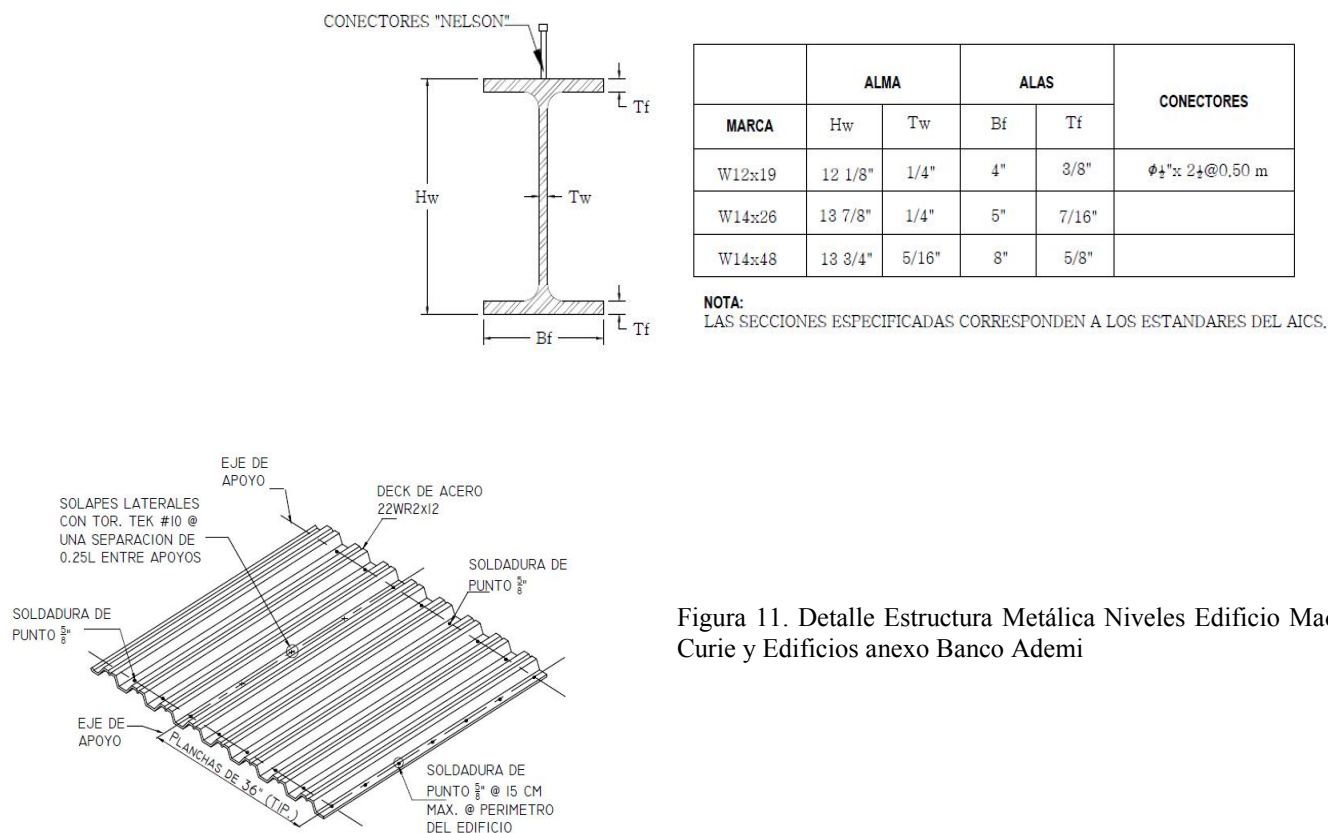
Detalle Estructura Metálica Niveles Edificio Madame Curie y Edificios anexo Banco Ademi
